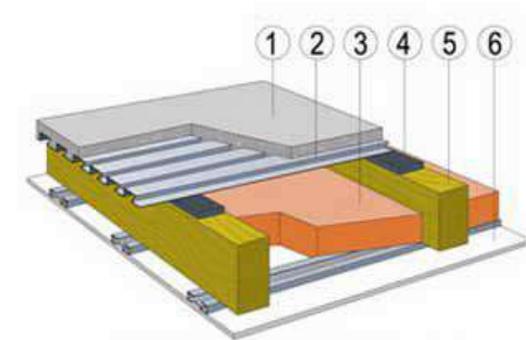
AISLAMIENTO ACÚSTICO MIXTO MAMPOSTERÍA
